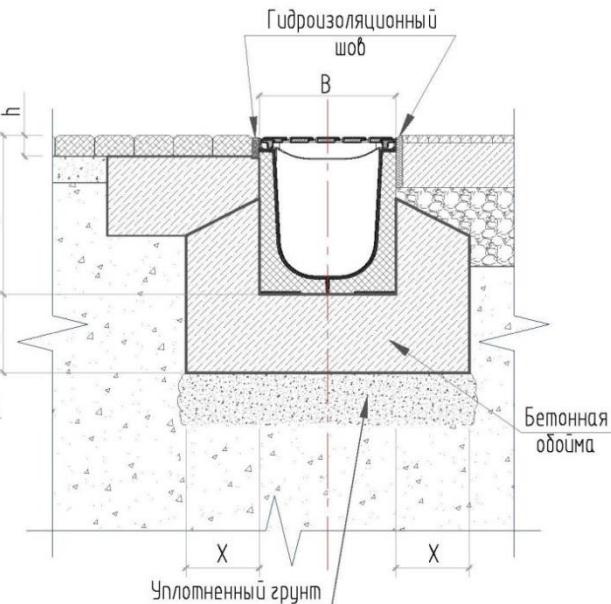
б – Устройство бетонной обоймы лотка с асфальтобетонным, бетонным покрытием и штучными элементами мощения для классов нагрузки от А15 до В125.
